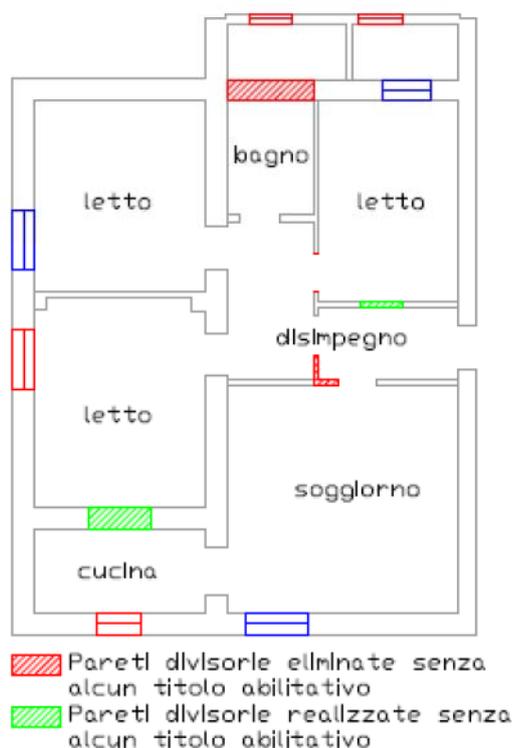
Planimetria dello stato reale dei luoghi con indicazione difformità rispetto alla planimetria catastale (cfr. all. 12)
